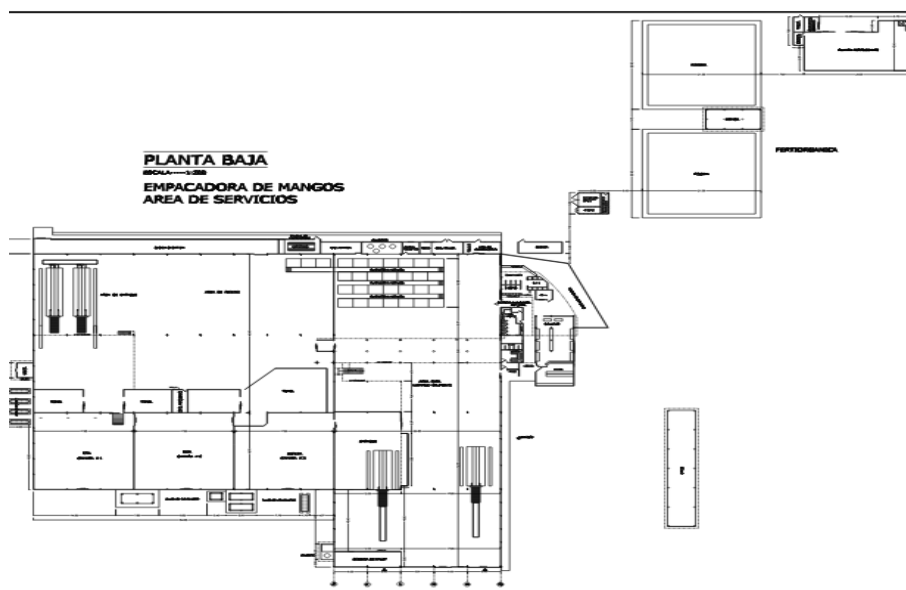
Plano de planta baja de empacadora de mangos BRESSON S.A.
